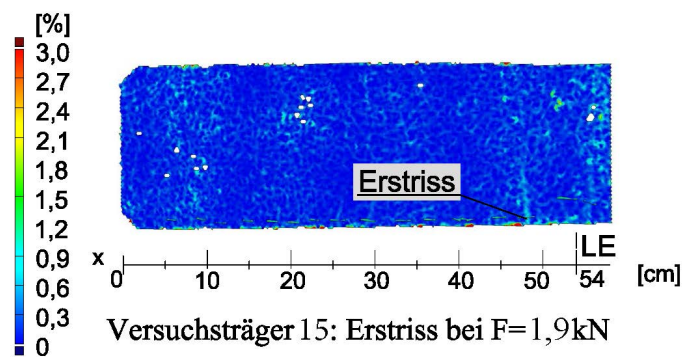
Versuchsträger 15- Lage Erstriss
